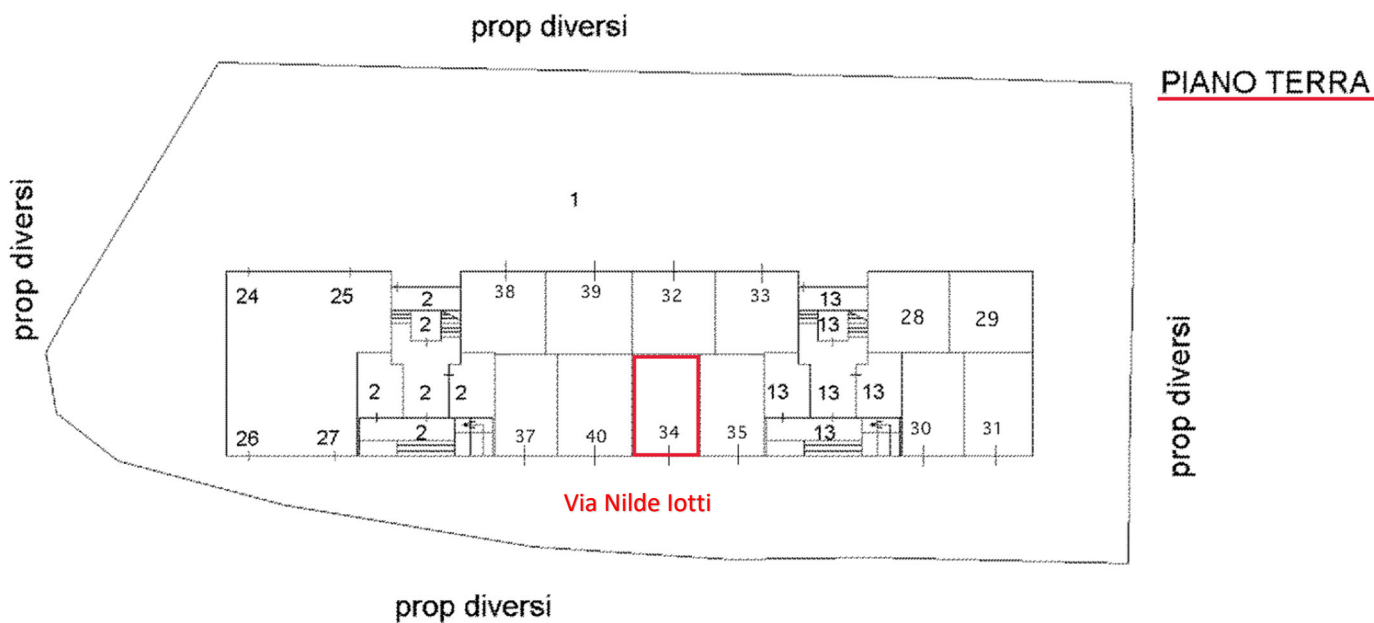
Ubicazione del cespite all'interno del Fabbricato (Stralcio dell'elaborato planimetrico catastale)
